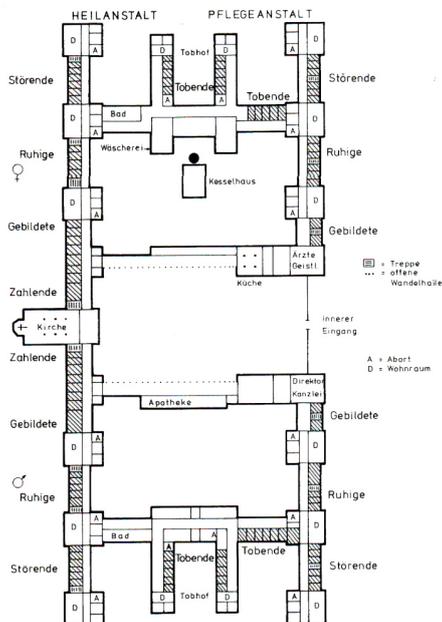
Grundriss Heil- und Pflegeanstalt Illenau
